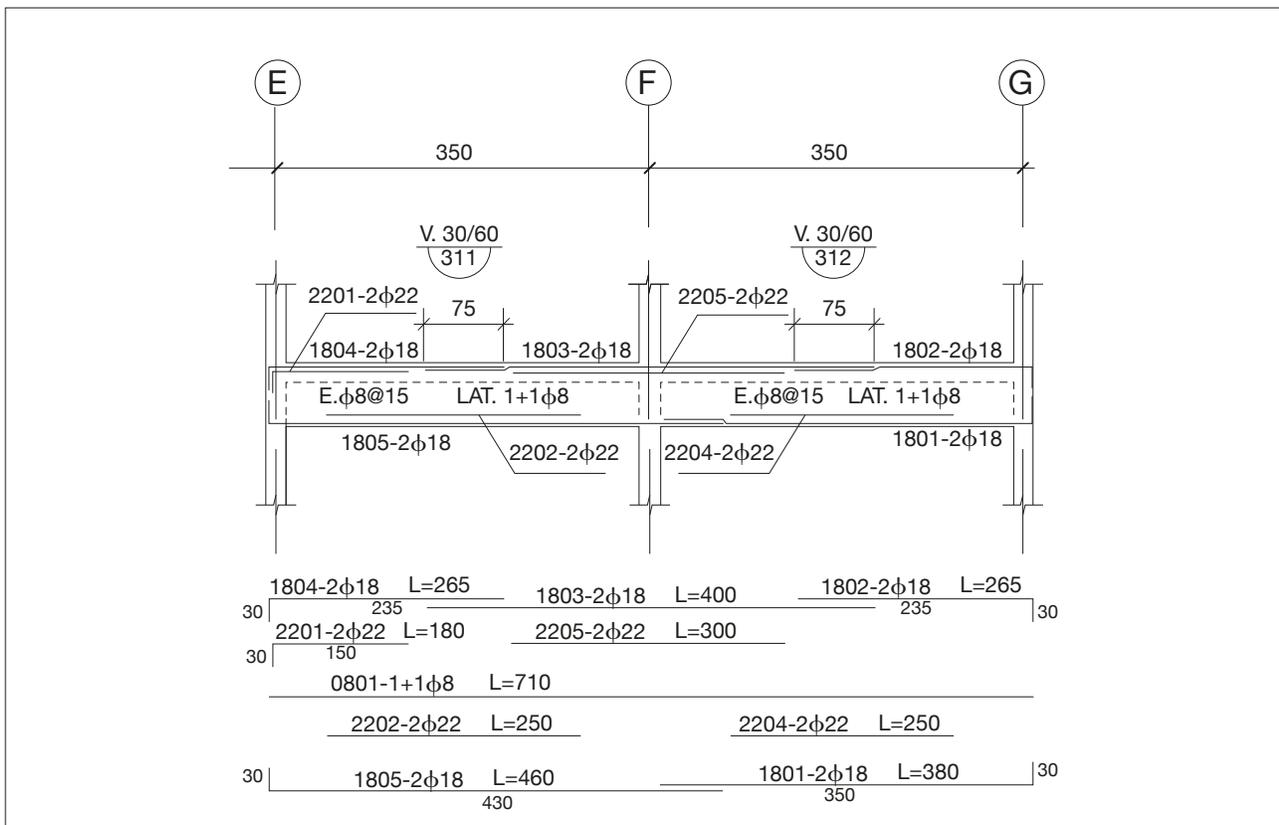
Plano de Detalle Viga 312 (fuera de escala).
